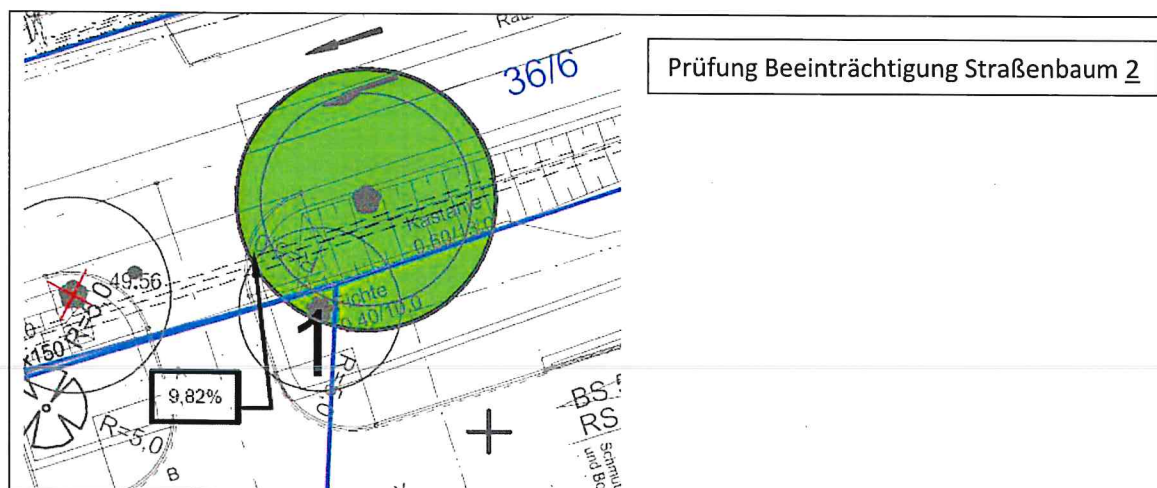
Straßenbäume Rodung, Quelle Auszug Lageplan Sichtweiten iBl Schwerin 06/22
